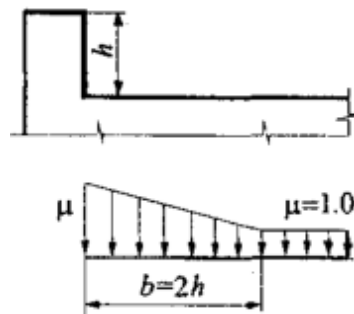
Схема снеговой нагрузки для покрытий с парапетами.
